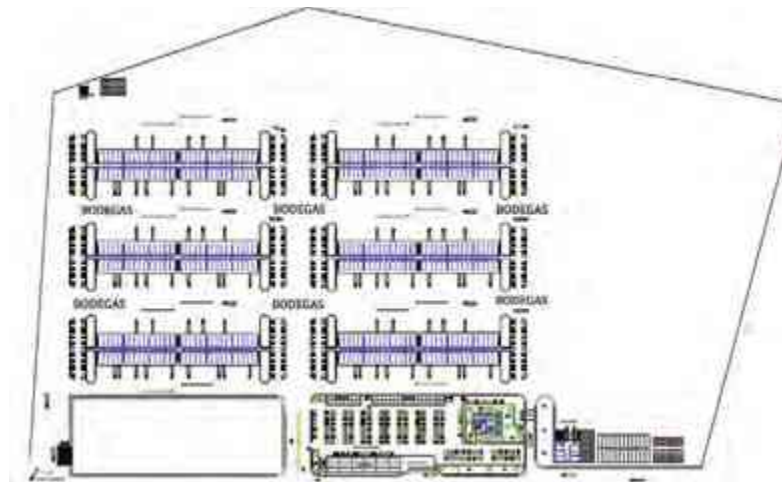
Planta arquitectónica No. 2 del proyecto. Imagen propia.
